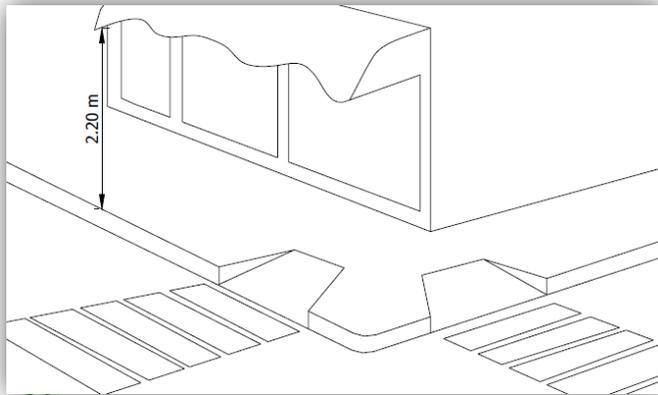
Fuente: manual de eliminación de barreras arquitectónicas MIDEPLAN/ caminamientos con esquina
